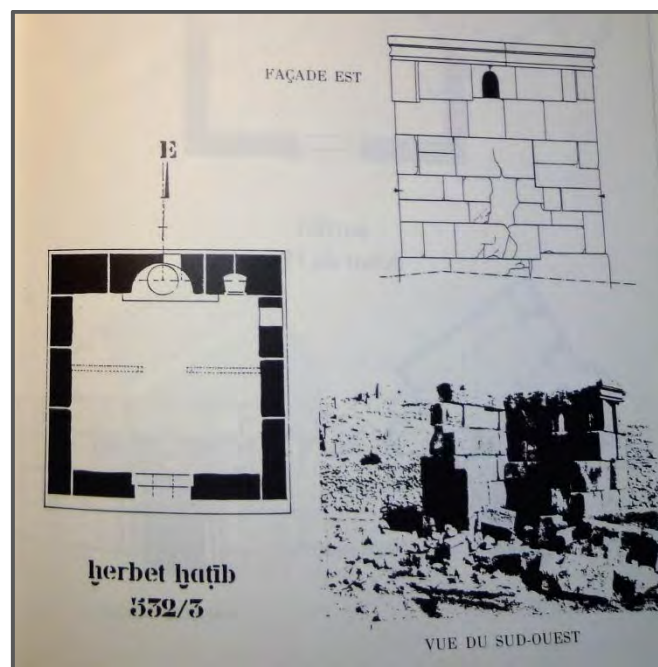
Khirbet el-Khatib. Pianta, alzato e vista del battistero (scala 1:180)
